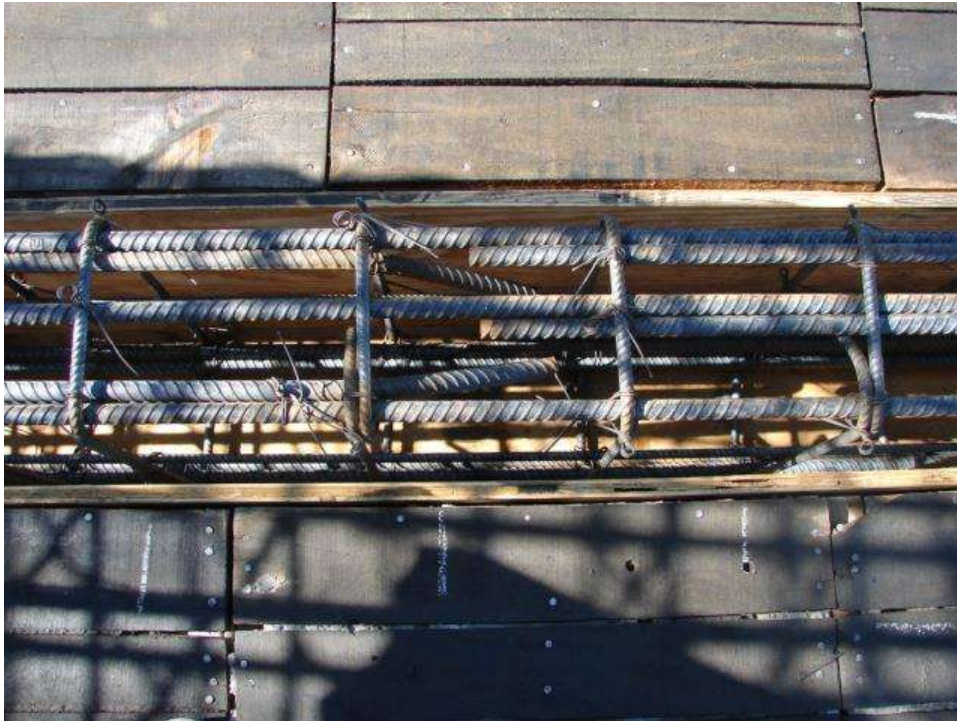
Armado de varilla para trabe empleada en la losa de la primera planta del edificio de la F.C.C.A de la U.M.S.N.H.
